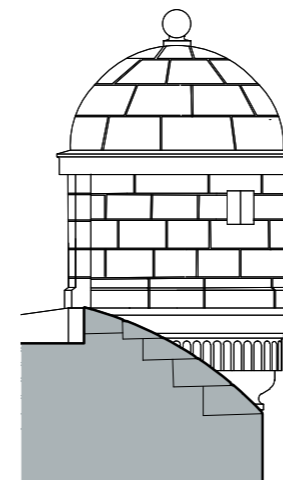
Parapeto abocelado de cantería. Proyecto de restauración. (MJB 2010).
